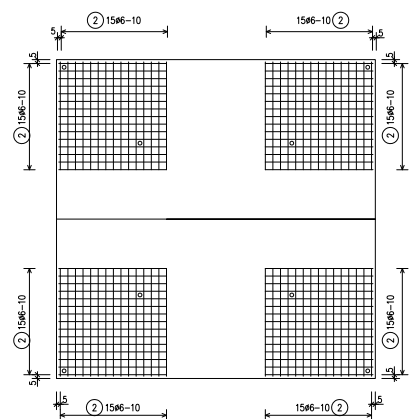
Platte 1, obere Eckbewehrung in
